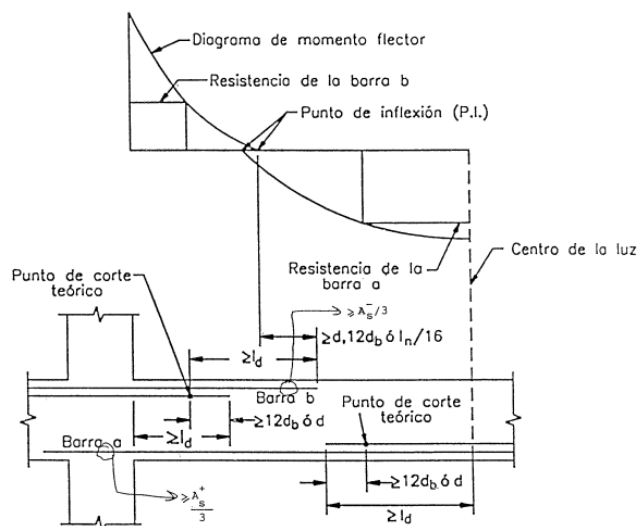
Disposiciones para el seccionamiento de refuerzo en vigas. Tomado de “Apuntes del curso Concreto Armado I”, por Ottazzi, 2015, p. 501.
